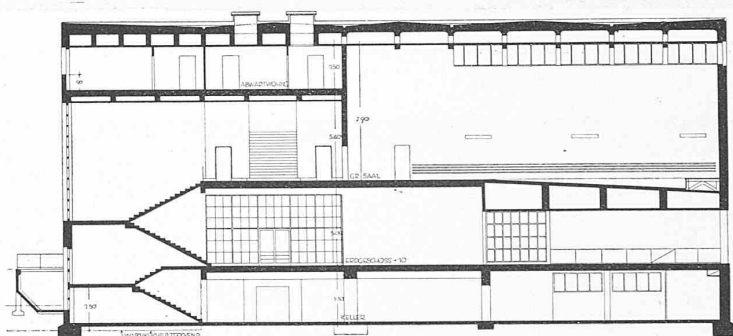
Längsschnitt des Kopfbaues an der Ausstellungstrasse.
